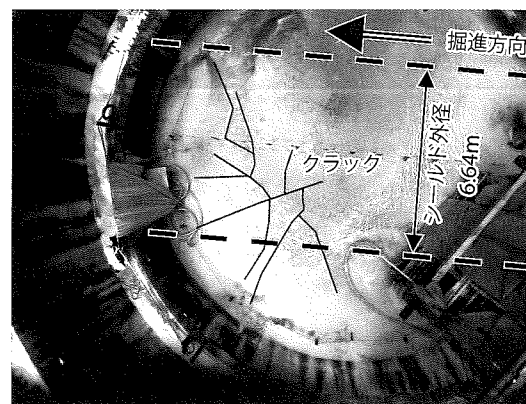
流動化処理土表面ひび割れ発生状況
